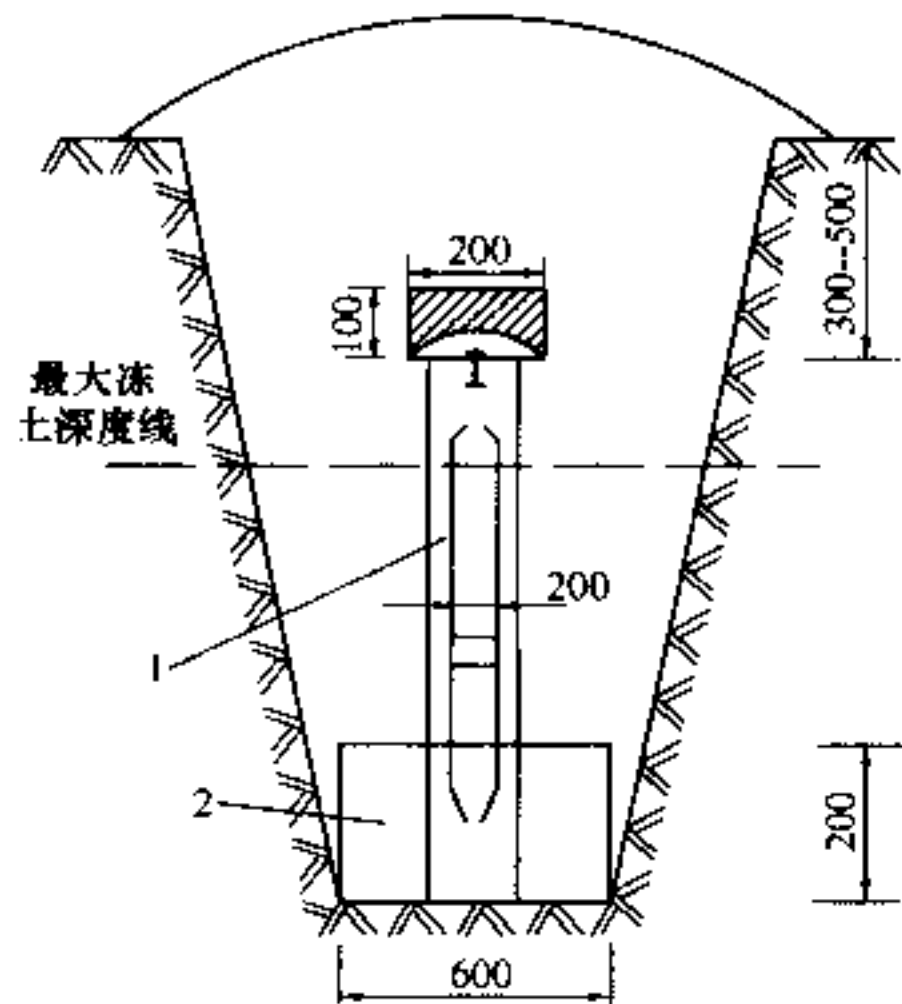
深桩水准点标志埋设 (单位: mm)
